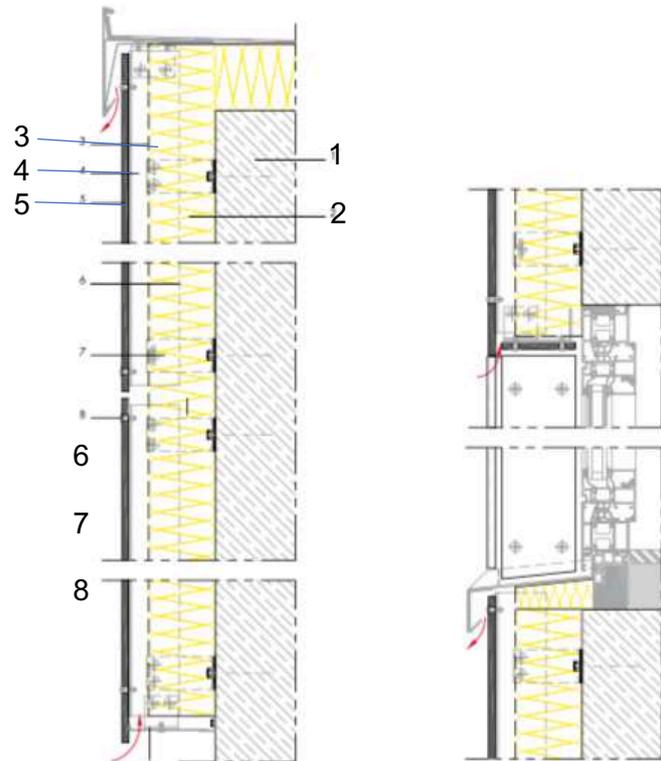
Sistema de fijación vista con remaches a una subestructura metálica. MODELO TS700.
